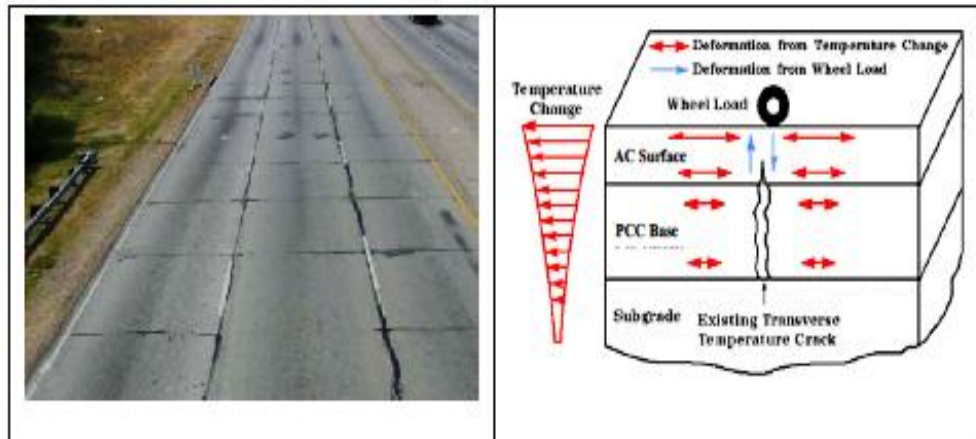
Fatiga por reflexión en sobrecarpetas asfálticas de pavimentos PCC
